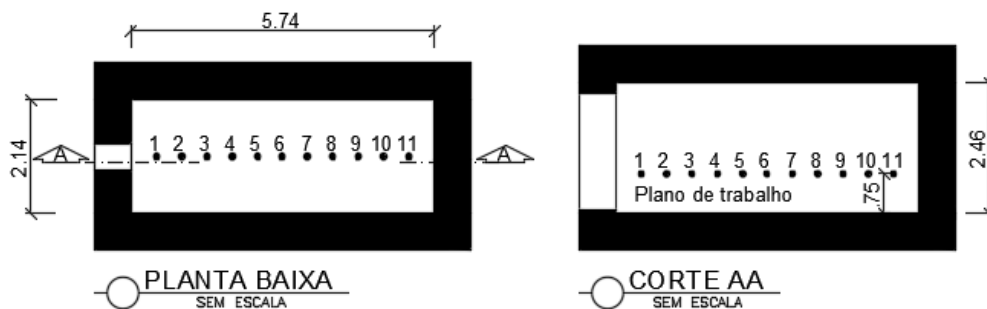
Planta baixa esquemática com pontos para cálculo das iluminâncias.
